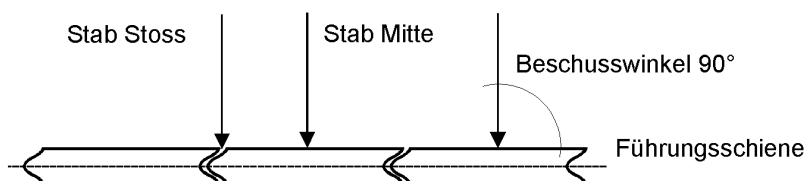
Beschussorte und Beschusswinkel beim Rollladen als Dachbauteil im Seitenriss
